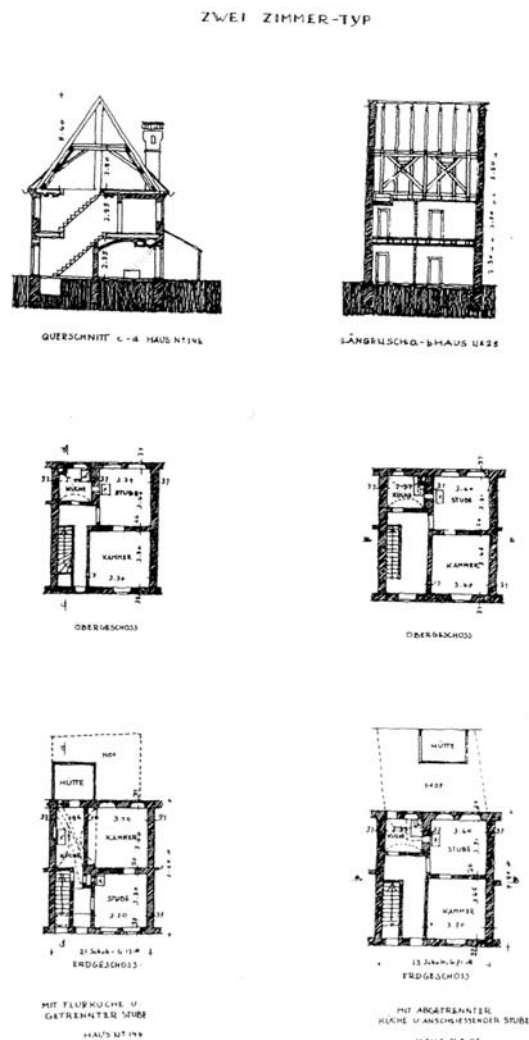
(Stadt, K6) Grundriss und Schnitt des 2-Zimmer-Typ-Hauses der Fuggerei, aus: Tietz-Strödel, Marion: Die Fuggerei in Augsburg. Studien zur Entwicklung des sozialen Stiftungsbaus im 15. und 16. Jahrhundert, Tübingen 1982, Abb. 8, S. 83.
